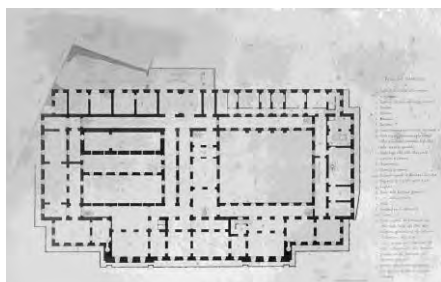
progetto Koch Banca d'Italia pianta sotterranei
